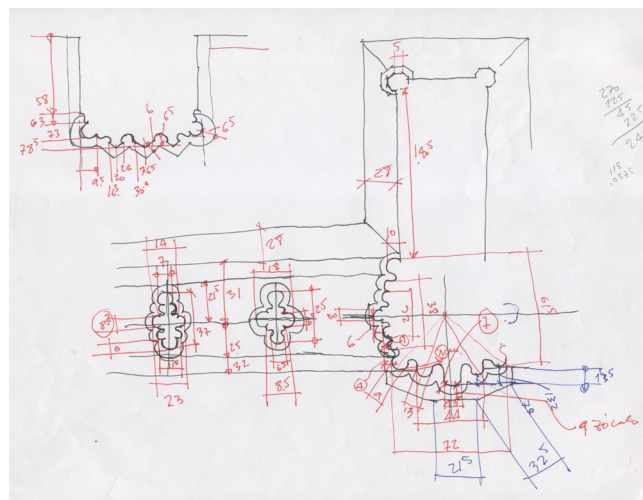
Detalle de documentación con cinta de la planta de la catedral de Burgos. Imagen: José Sandoval, IPCE.
